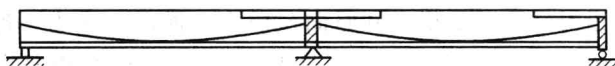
先简支后连续法施工连续梁的分段配筋示意图
